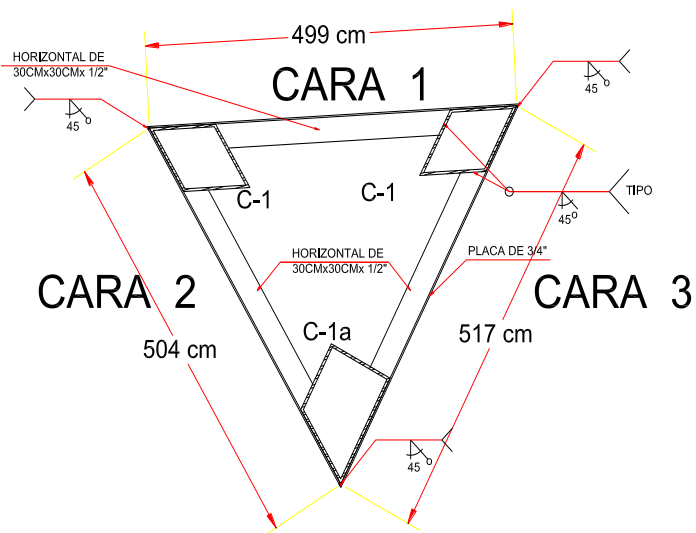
Corte (C-1 - C-1a) de un pilón.
